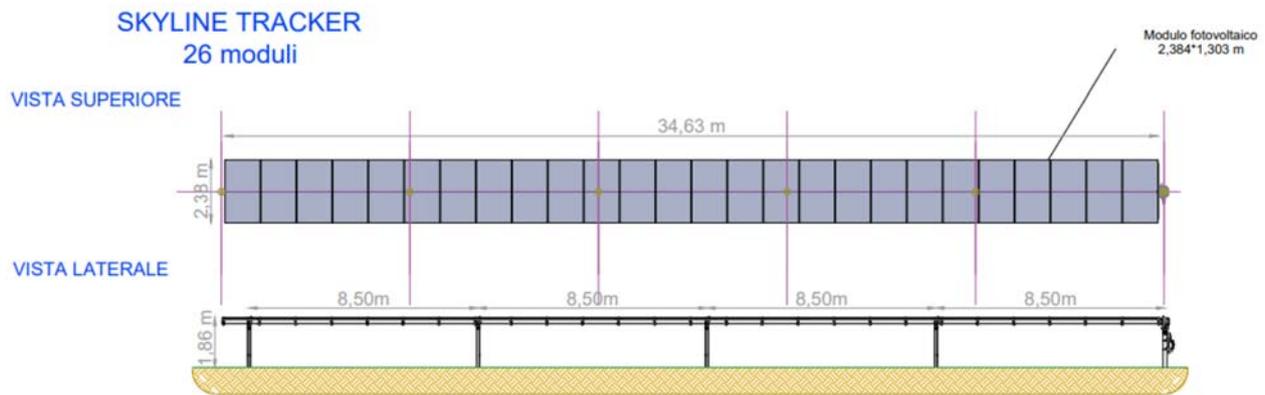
Vista superiore e vista laterale di 1 tracker da 25 moduli
